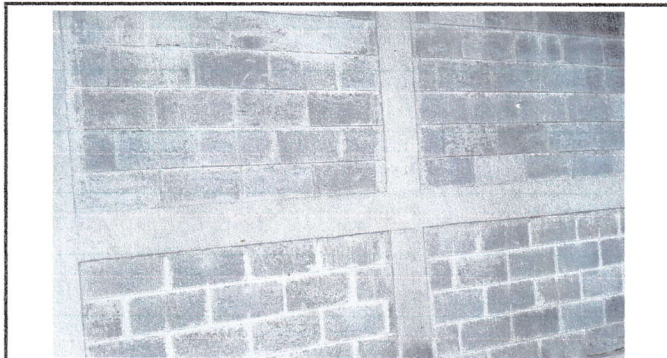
Modulo 4 Reparación de muro perimetral de block Renglon 15.1
